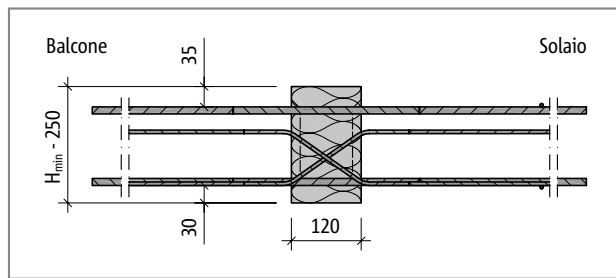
Schöck Isokorb® tipo DXT per CV35: sezione dell'elemento
